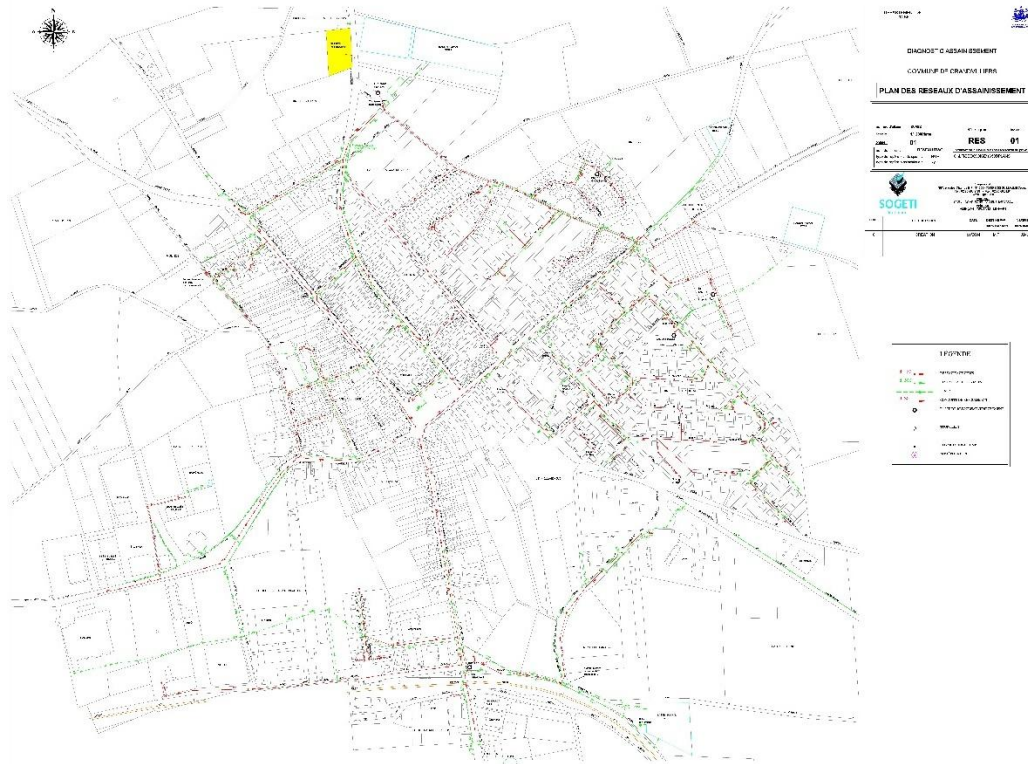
Plan des réseaux d'assainissement de Grandvilliers
